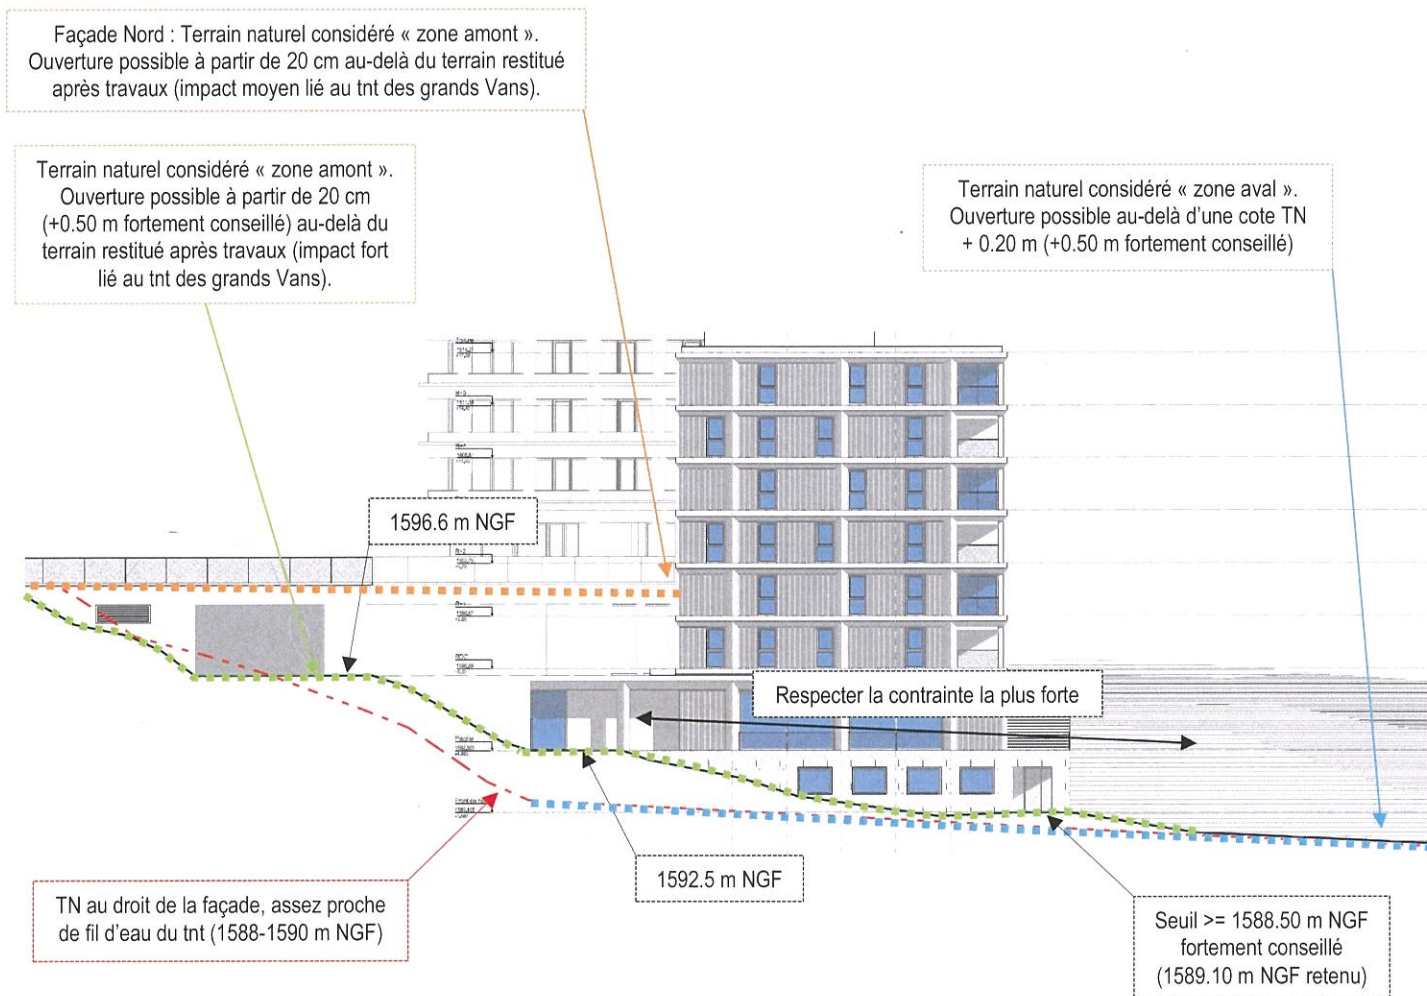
Schématisation du terrain naturel retenu Bât B façade Ouest
